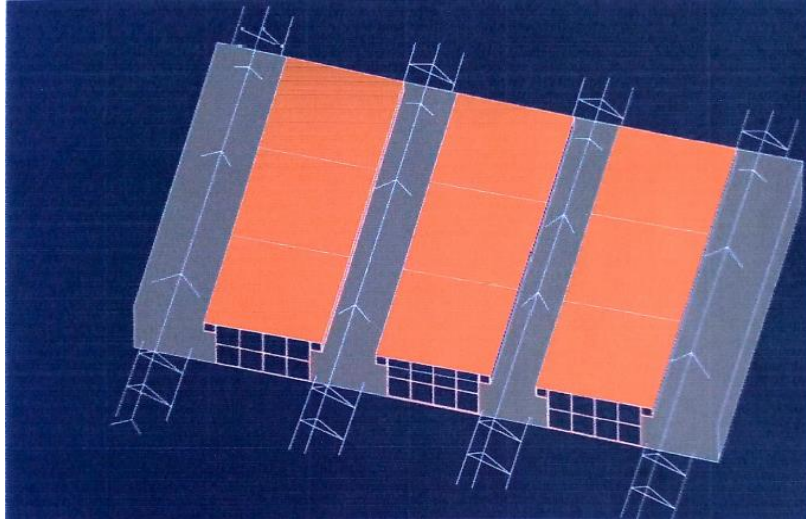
Schéma illustratif de la disposition constructive des planchers en hourdis
